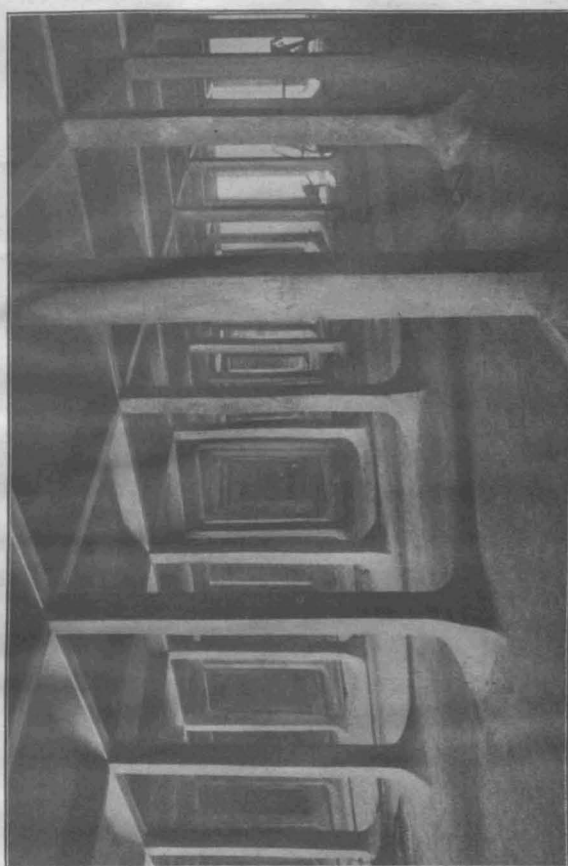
Inneres des unterirdischen Reinwasser-Beckens in Suez.
